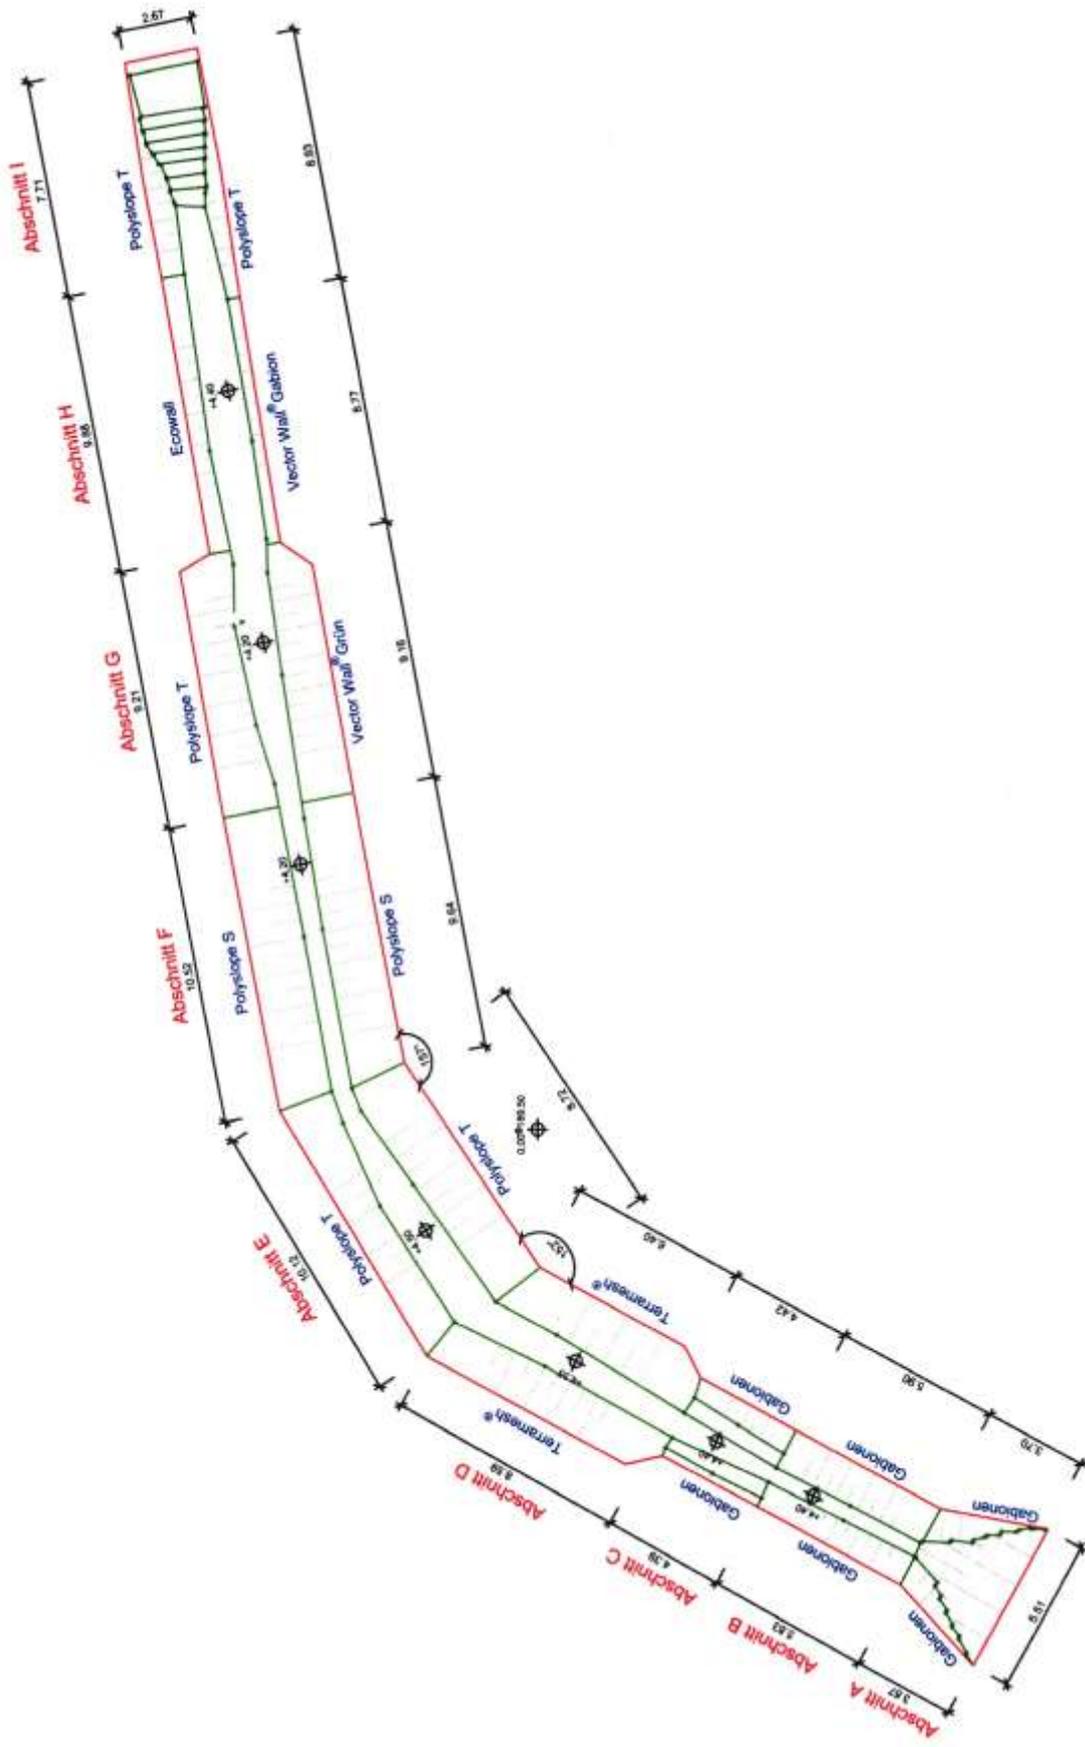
Lageplan Bauprojekt Seebarn (Quelle: FUCHS 2006)
